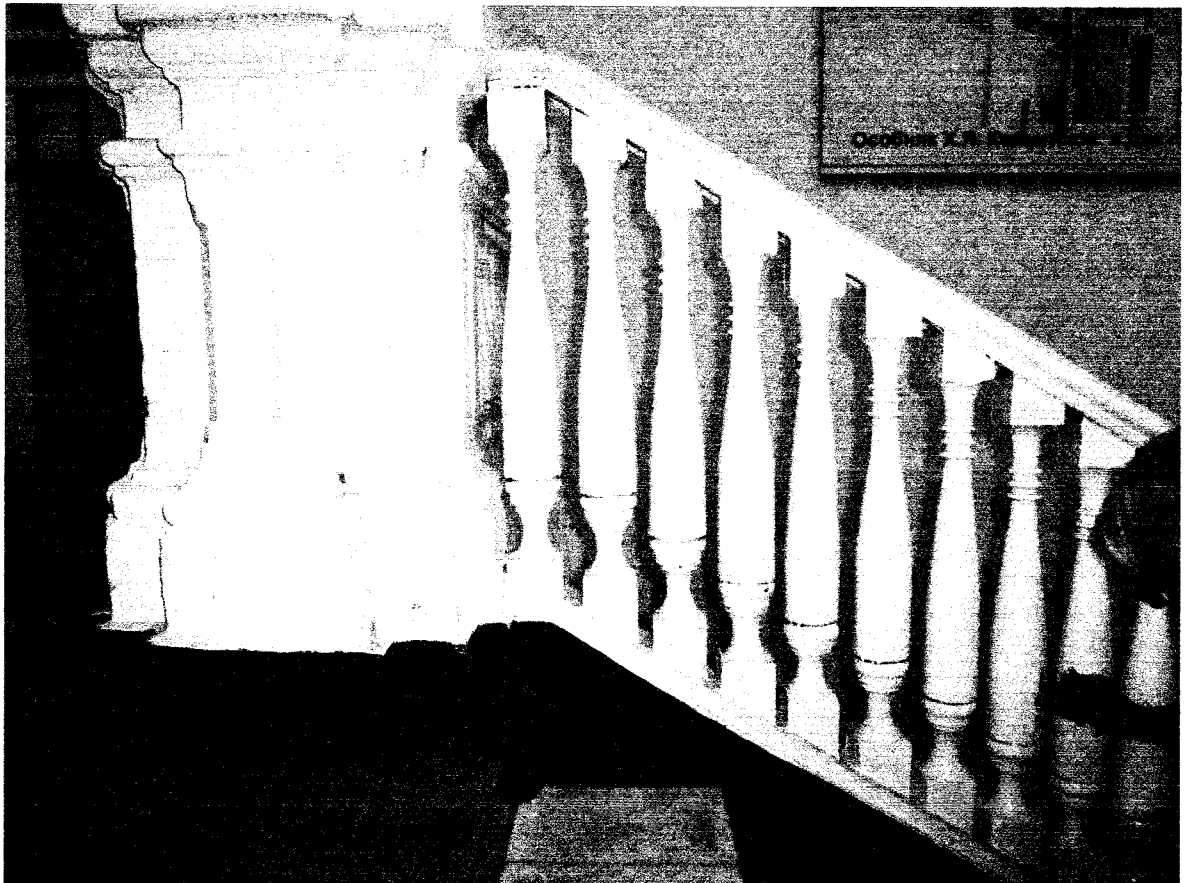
Первый этаж. Помещение 1. Ограждение лестницы
